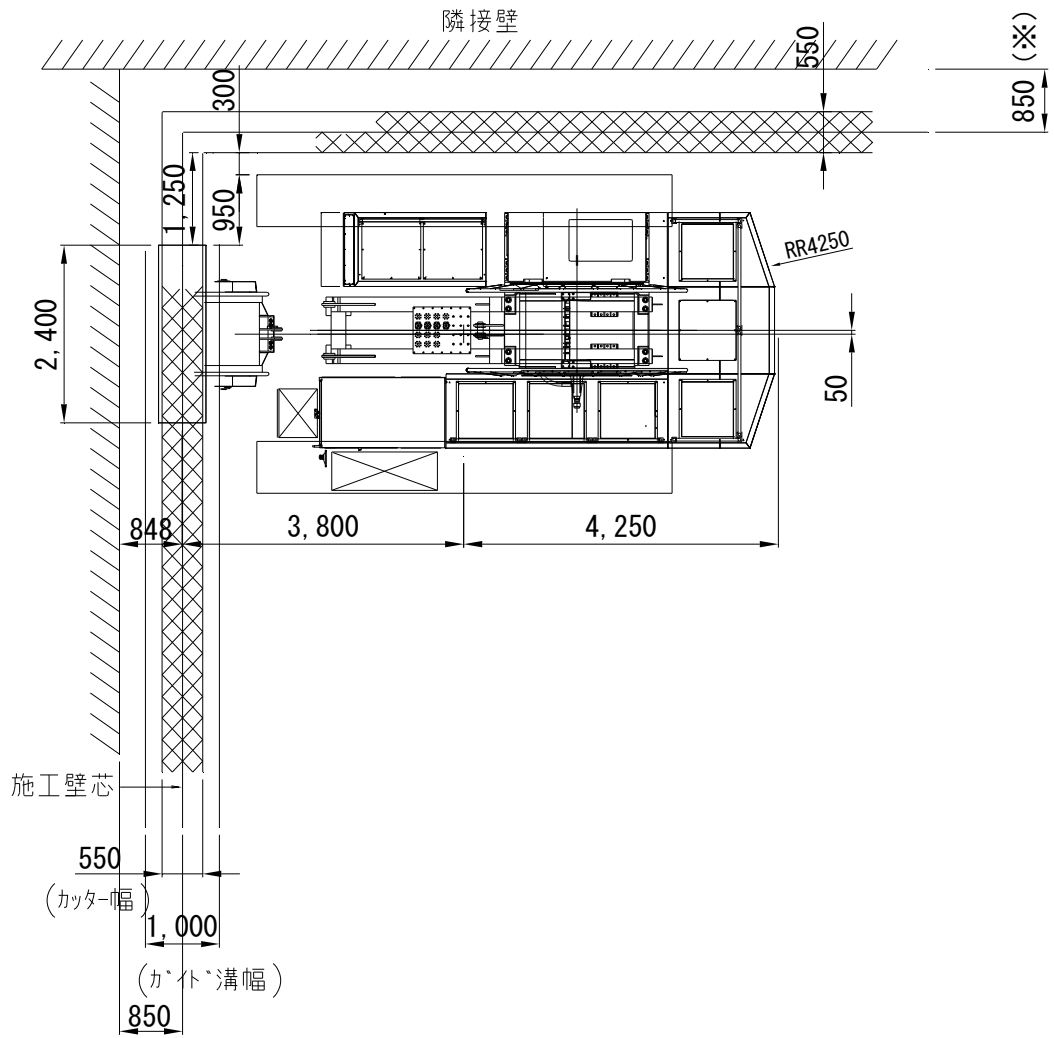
TRD工法機 (TRD-III型) 近接施工平面図
